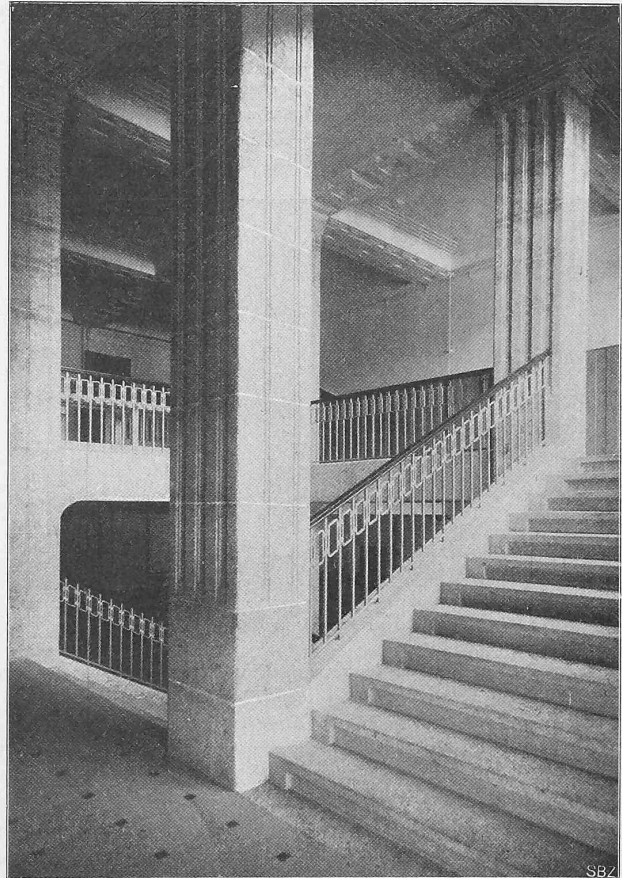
Endigung des Haupttreppenhauses im Dachgeschoss.
